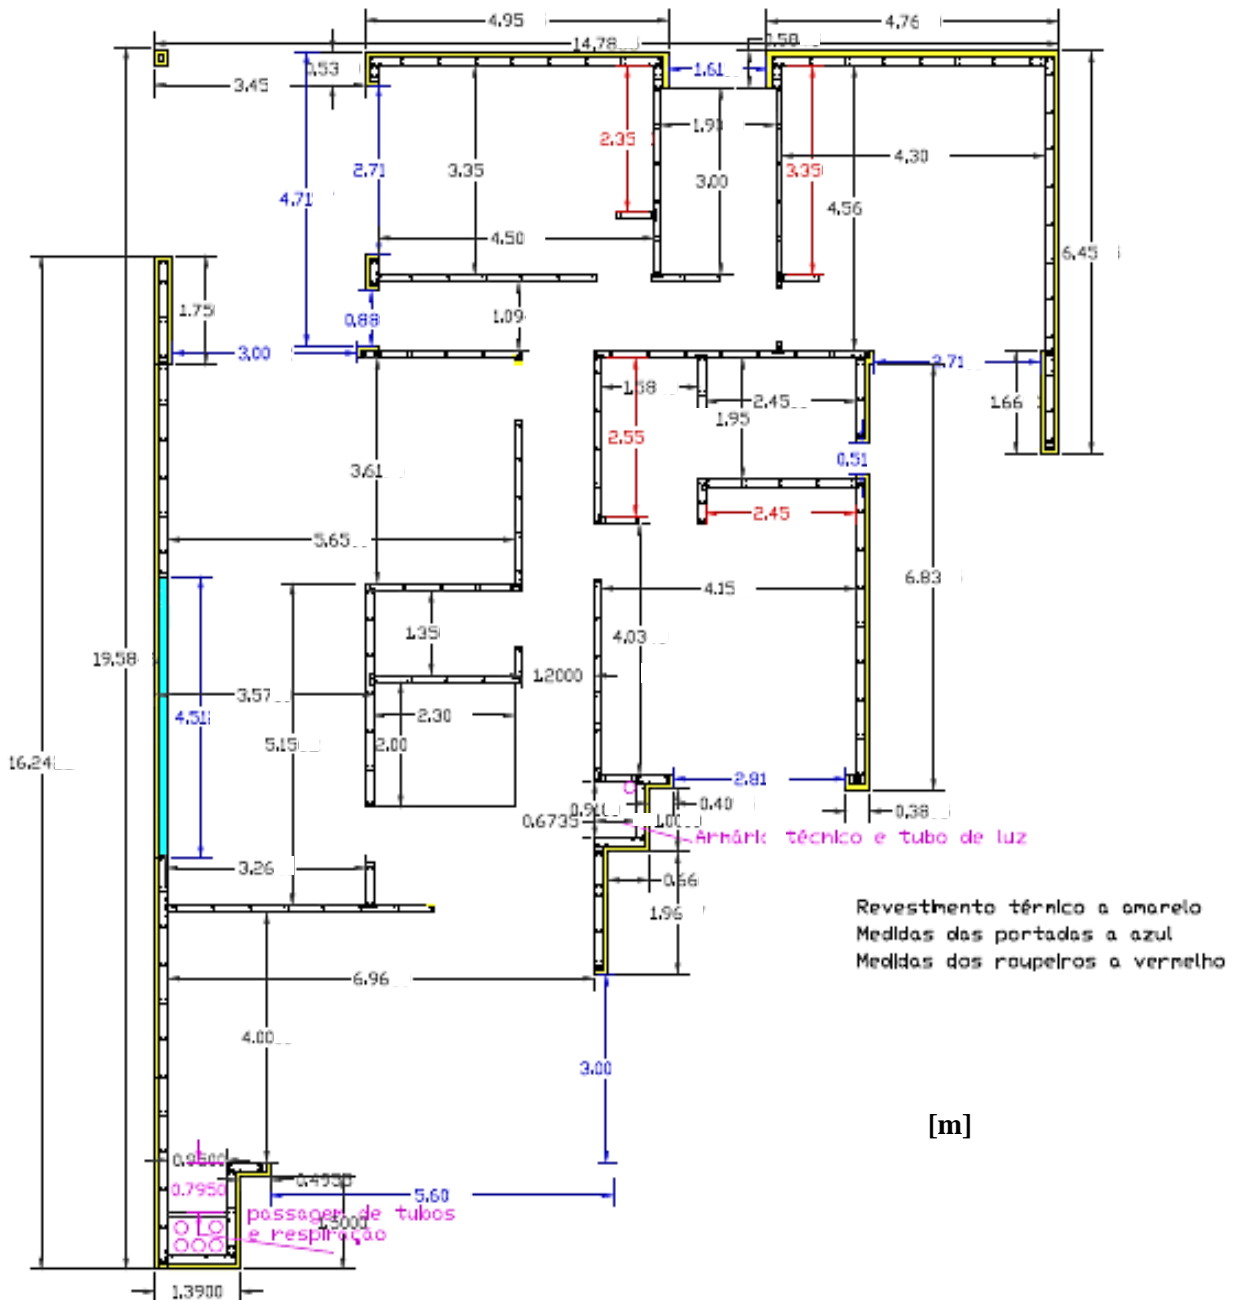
Planta da moradia da Ponta do Sol (Lombada)
